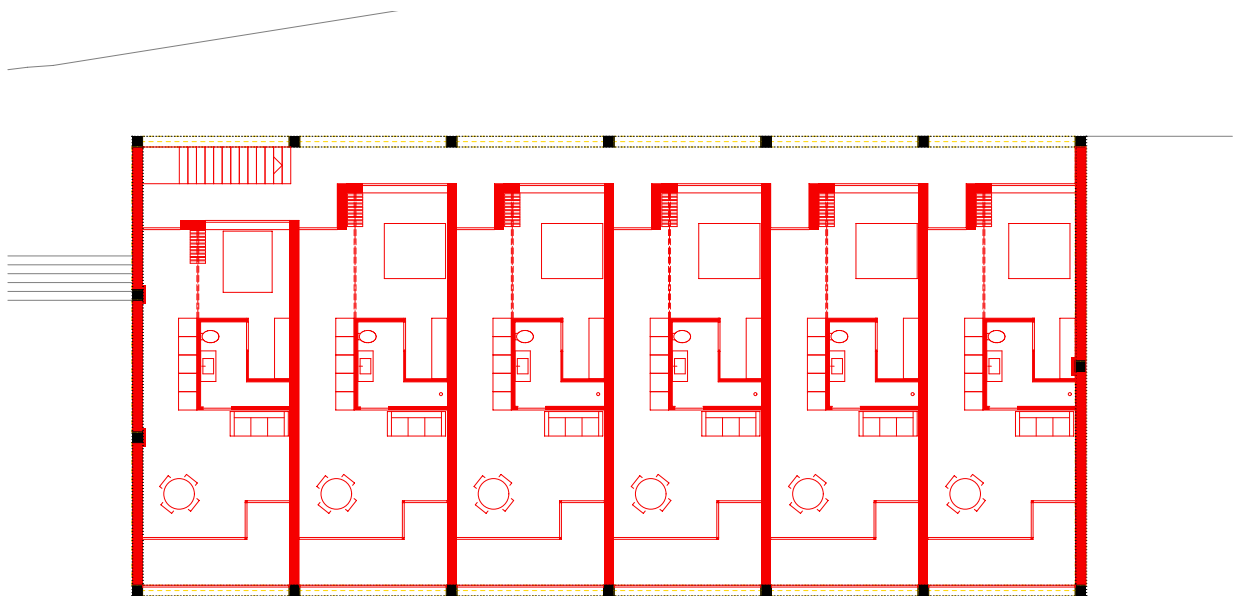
Grundriss Obergeschoss, TK 7 am 23.11.2023
